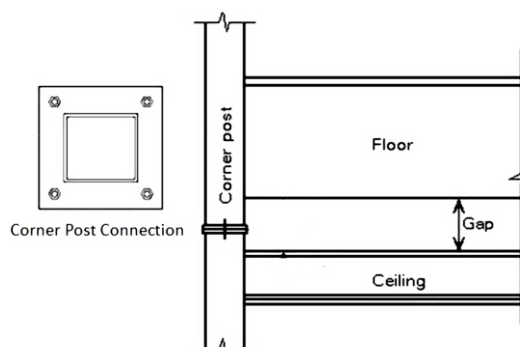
Ejemplo de conexión de 2 módulos 3D apilados Fuente: www.Steelconstruction.info
